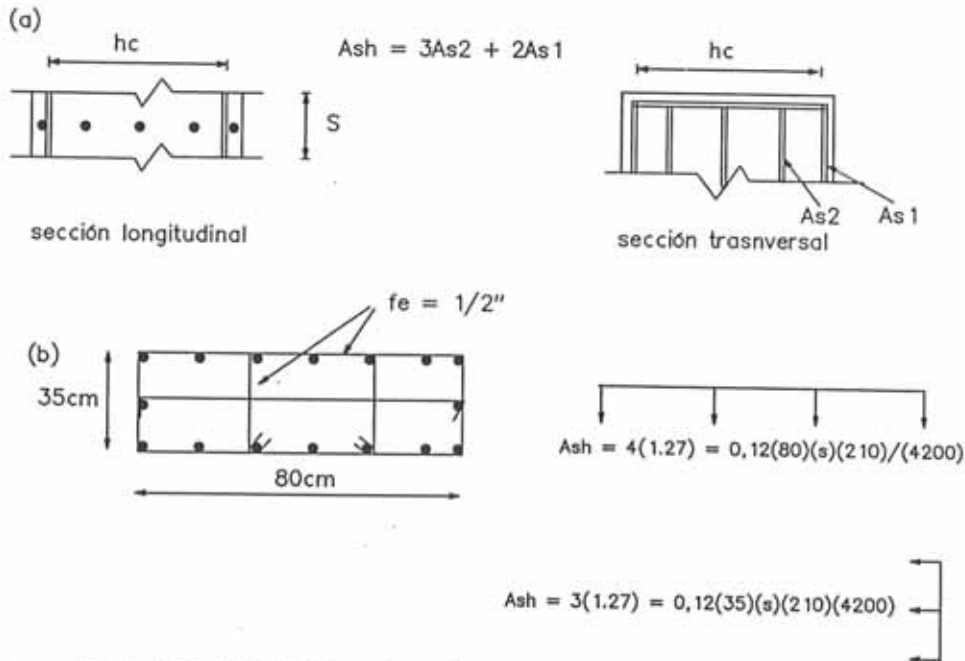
Definición del área de refuerzo transversal y separación máxima de barillas.
